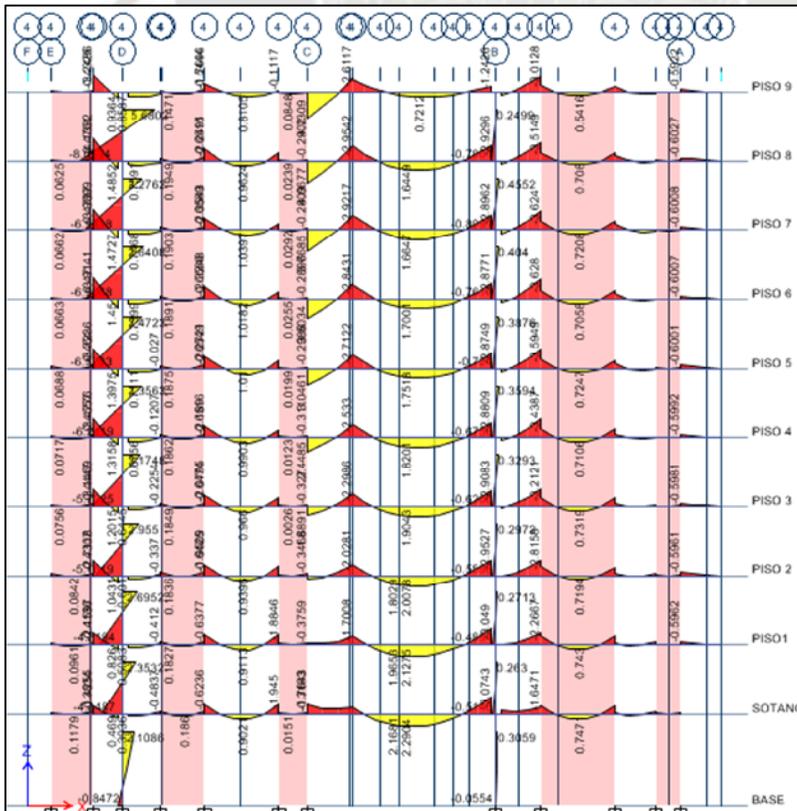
Fuerzas Internas Actuantes sobre el Pórtico “4” Debido a las C.M.
